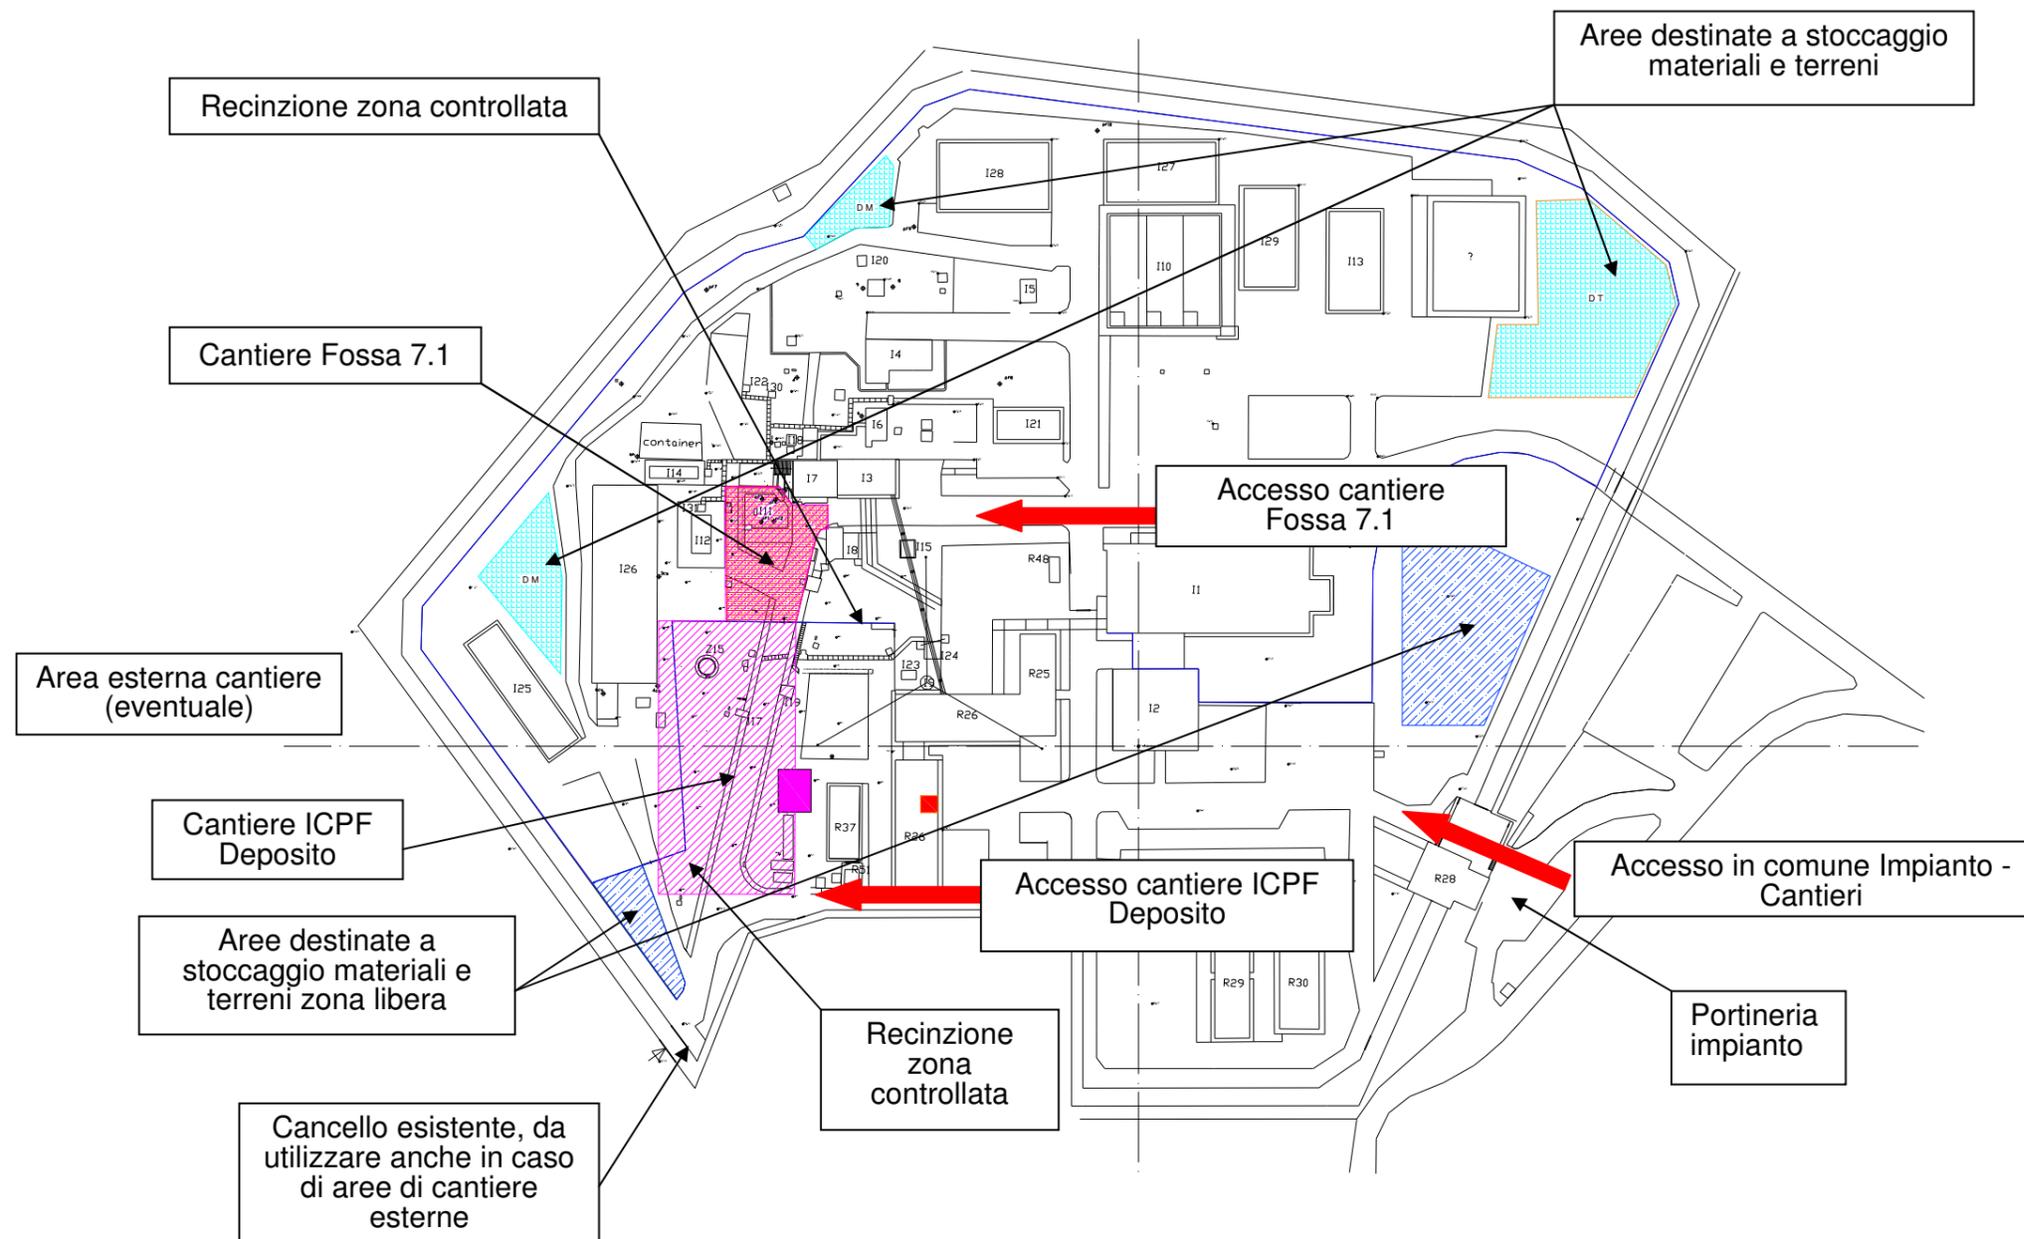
Fase di cantiere Fossa 7.1 – Inizio cantiere ICPF sezione Deposito
